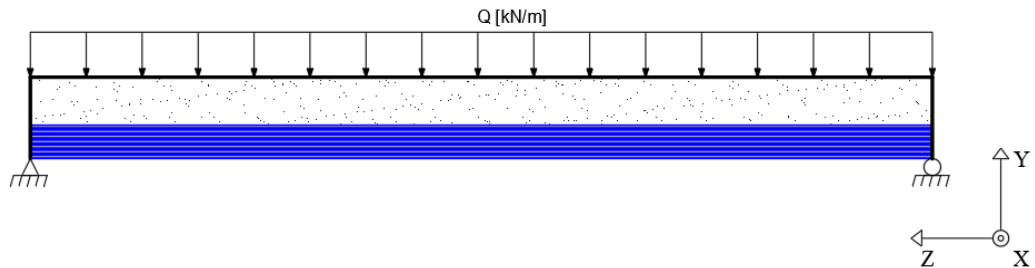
Laje mista simplesmente apoiada submetida a carregamento uniformemente distribuído.
